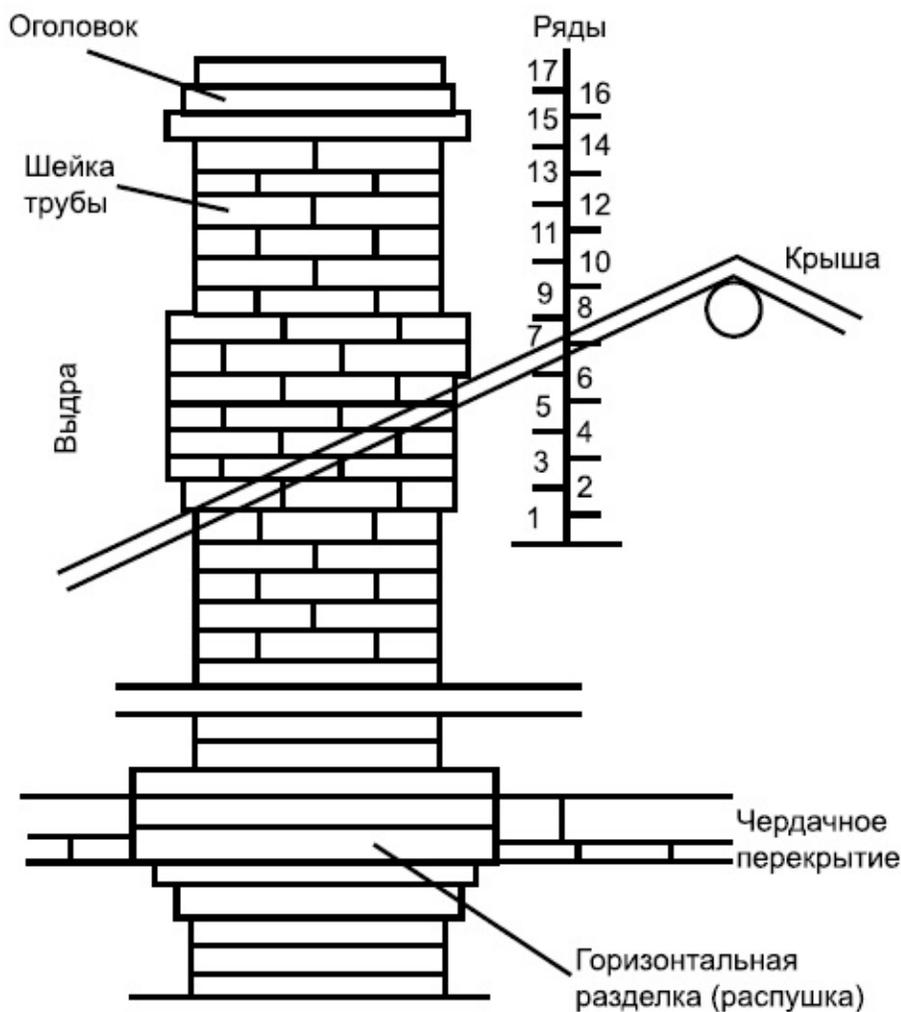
Устройство дымовой трубы Кладка выдры, шейки, оголовка трубы
